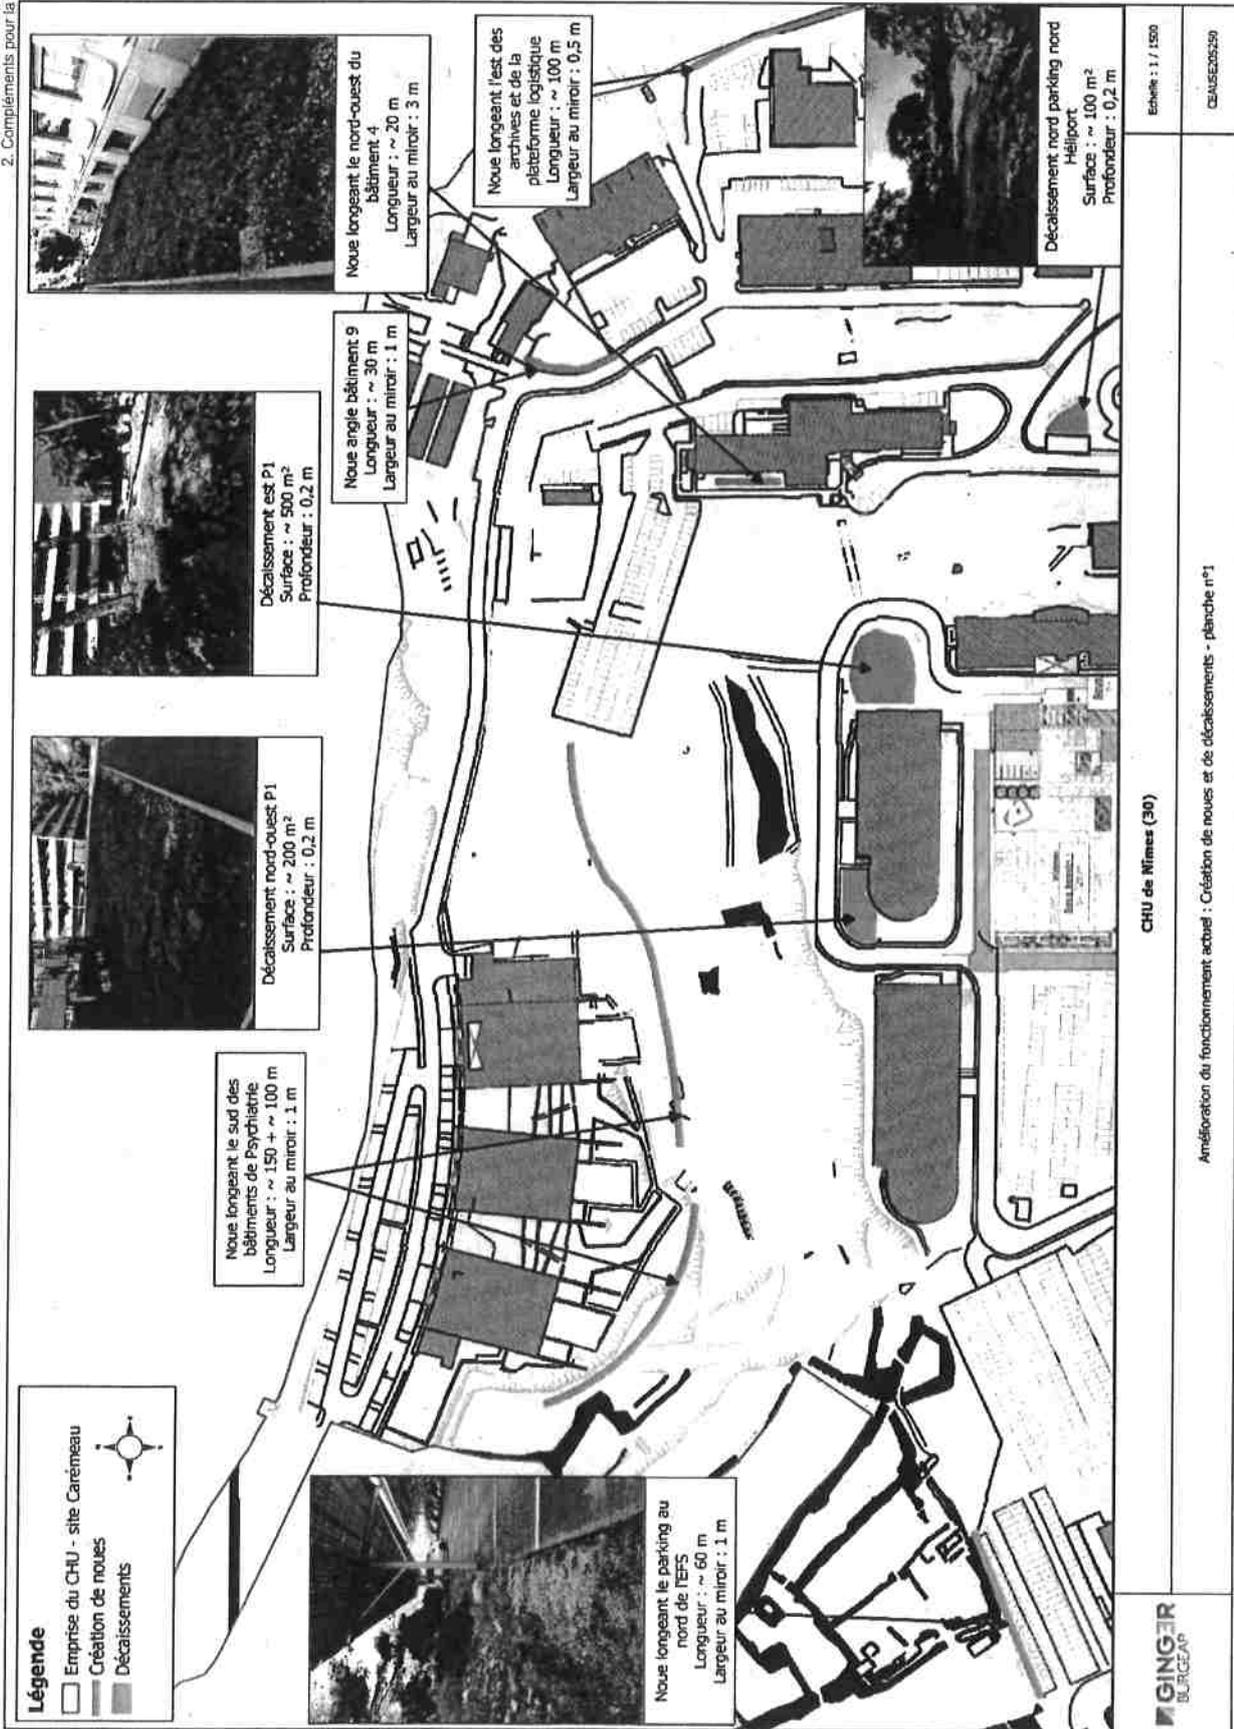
Amélioration du fonctionnement actuel, création de noues et de décaissements, planche n°1 (source : GINGER BURGEAP sur plan de masse du CHU)
